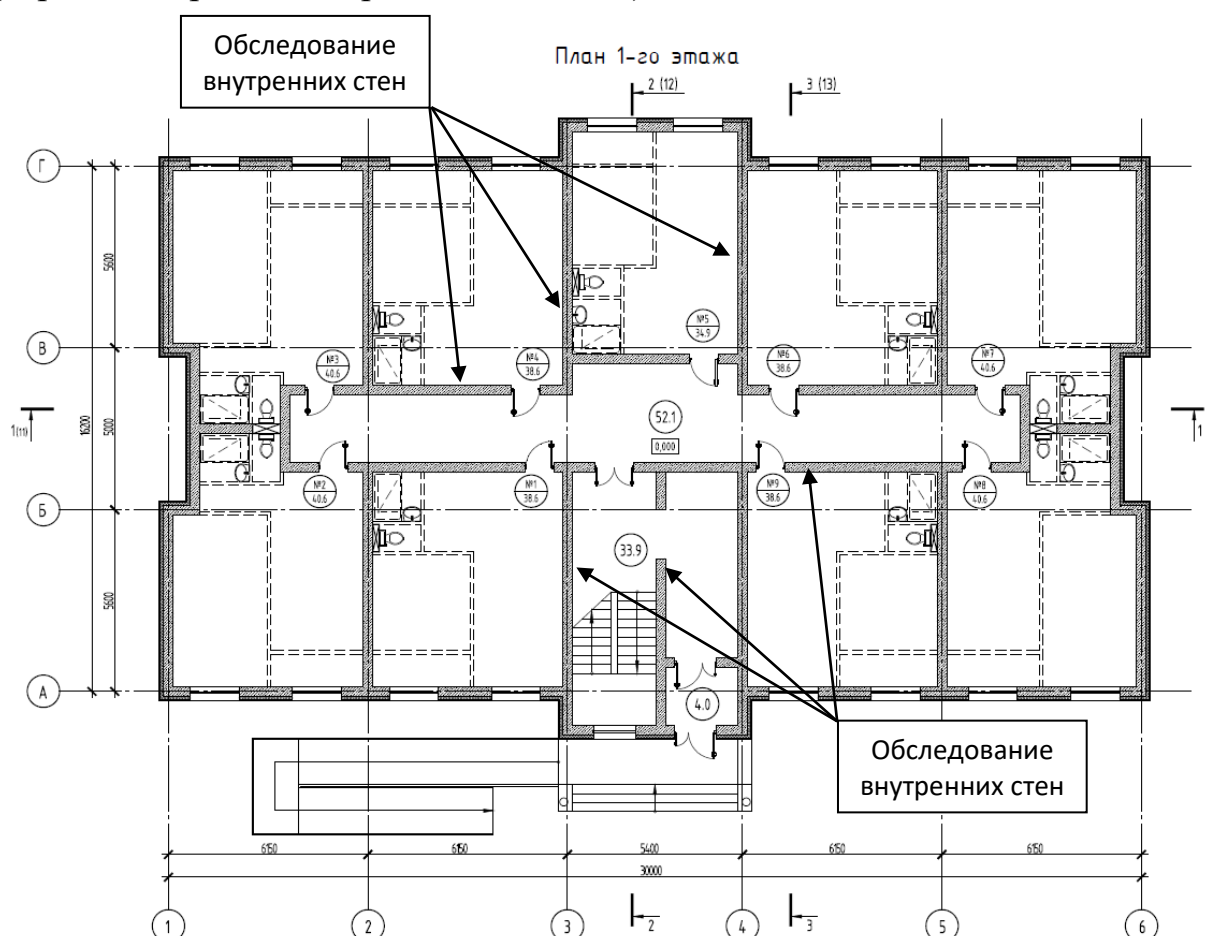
План на отм.0,000 (первый этаж). Обследование внутренних стен
